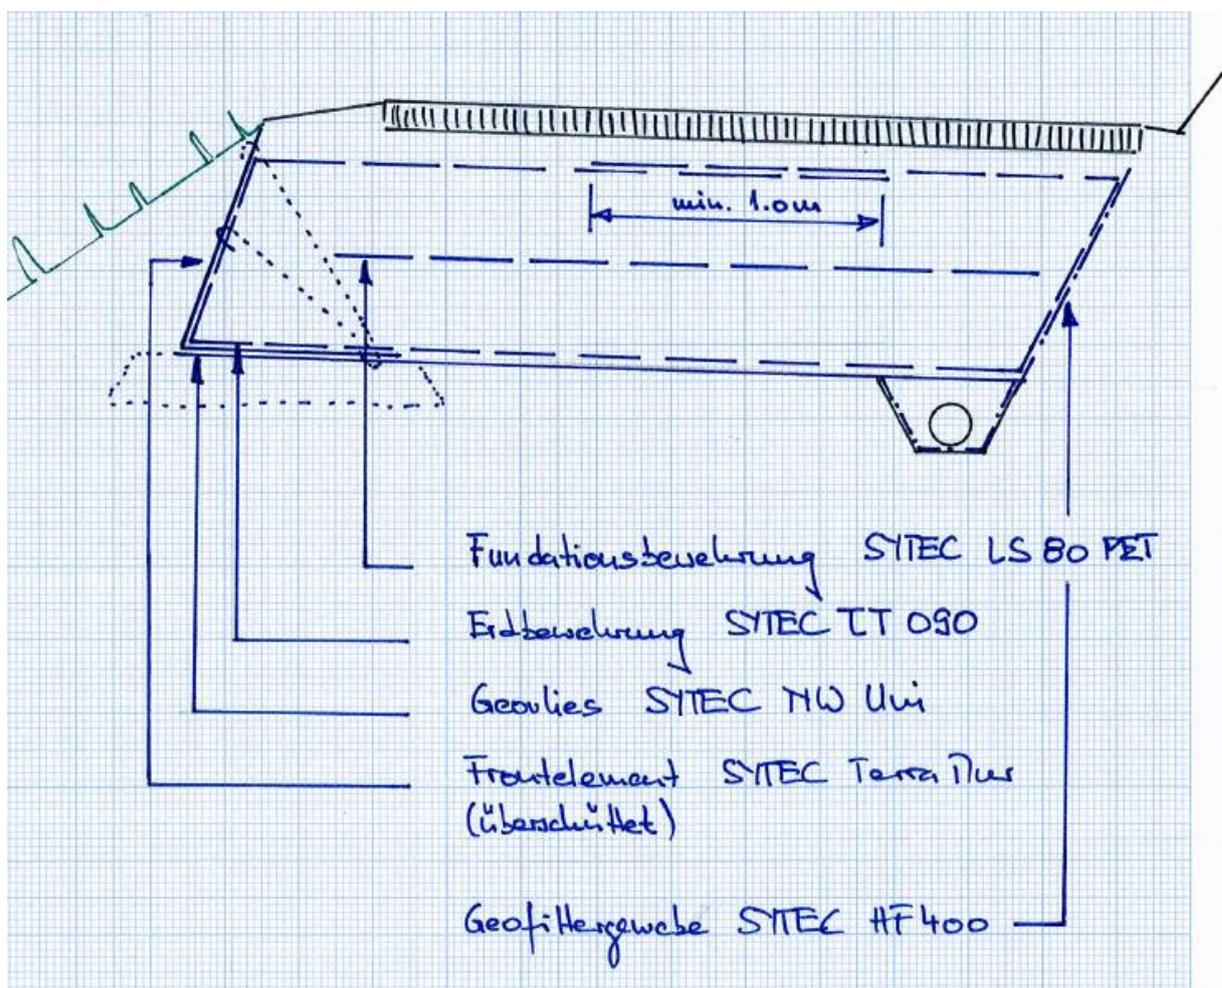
Oberbau mit Fundamentsbewehrung und Stützsystem.
